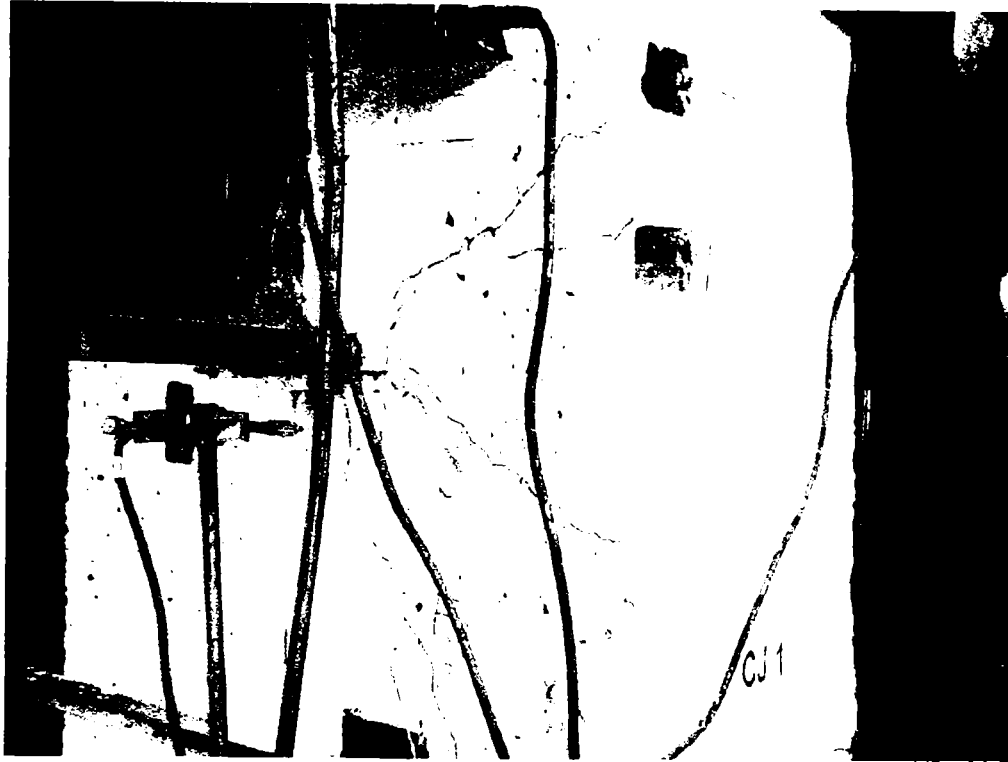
Dezvoltarea fisurilor - vedere laterală
